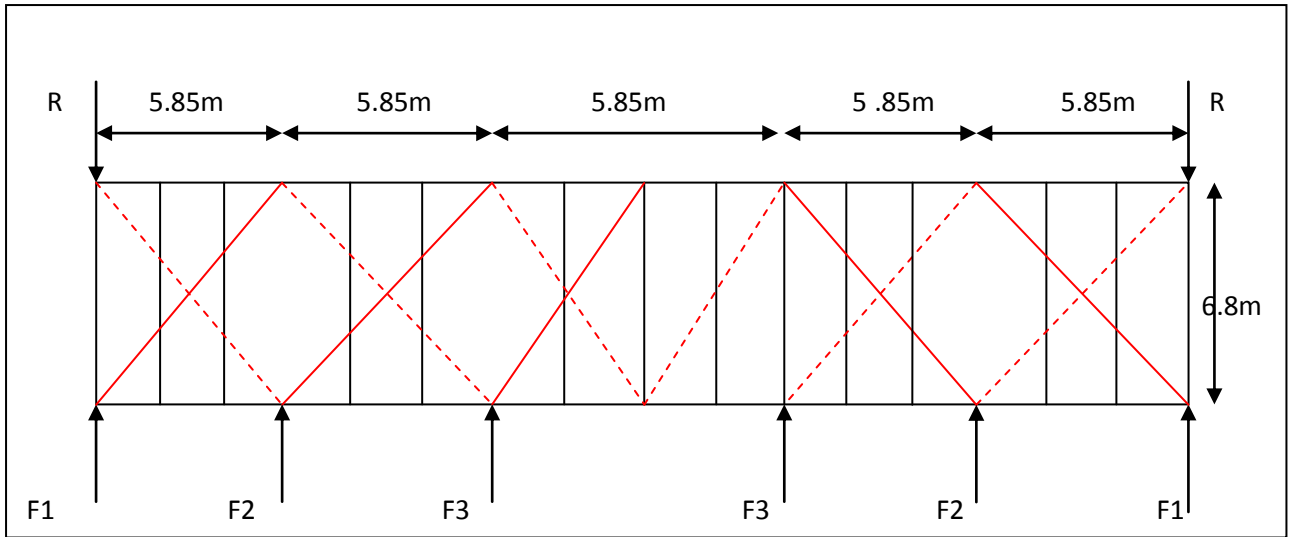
Schéma statique de la poutre au vent (effet de traction).
